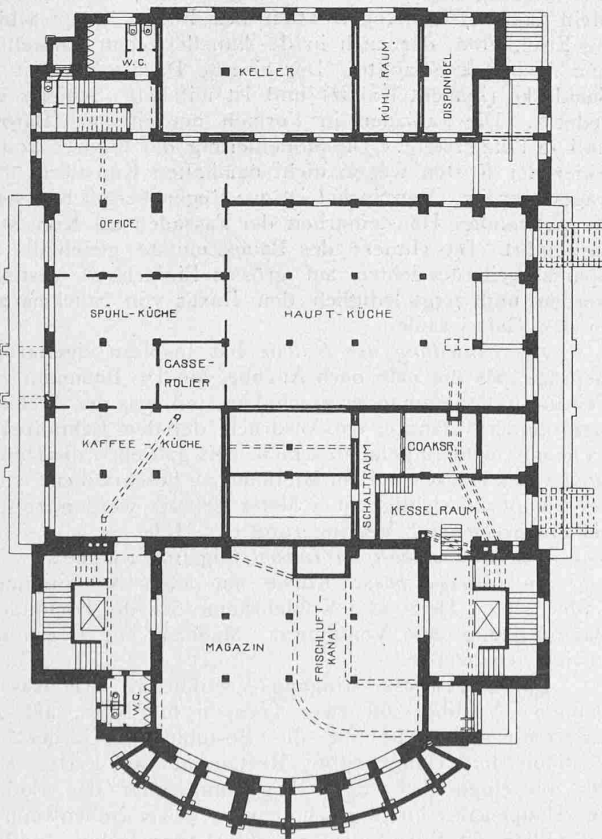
Grundriss vom Kellergeschoss.
